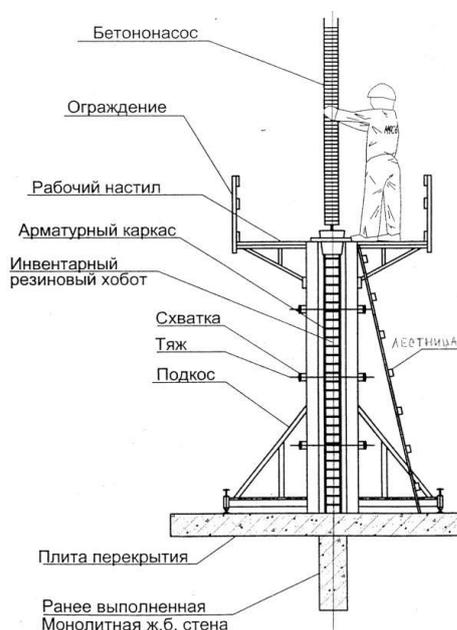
Бетонирование стен при помощи автобетононасоса
